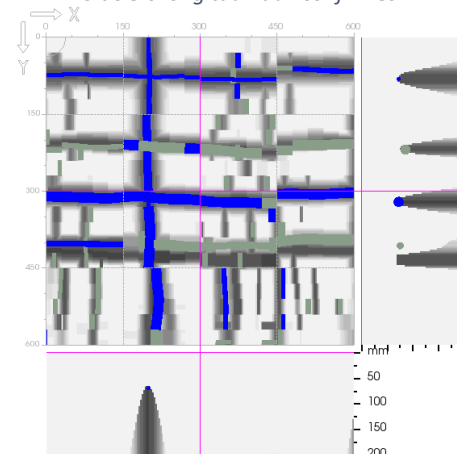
Poutre Pt05 – Travée 4 à mi-travée
